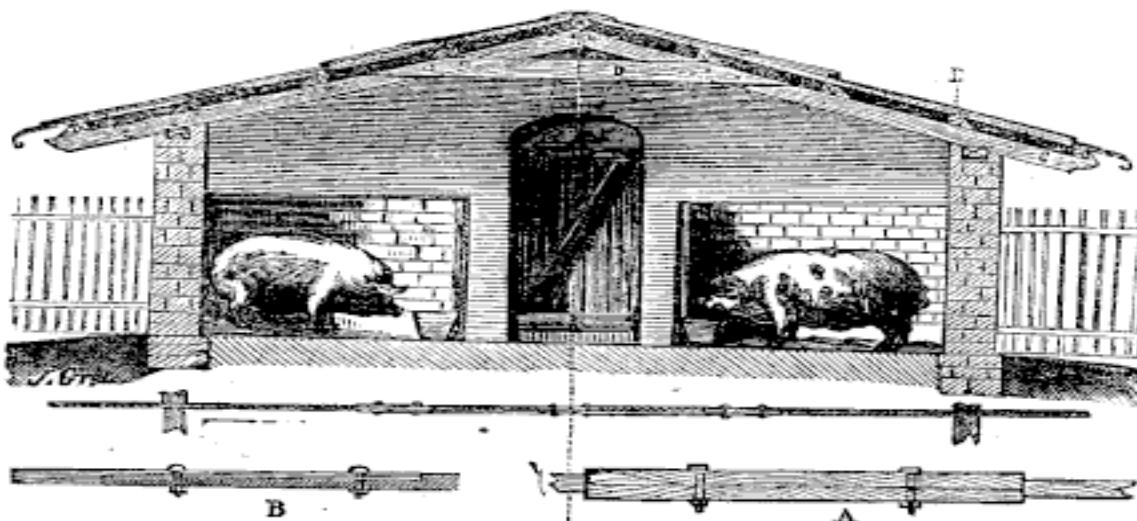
Coupe transversale de la porcherie double (tête à tête) de Grignon. — FIG. 54 bis. Plan de la charpente. — FIG. 54 ter. Plan des détails d'assemblage.
